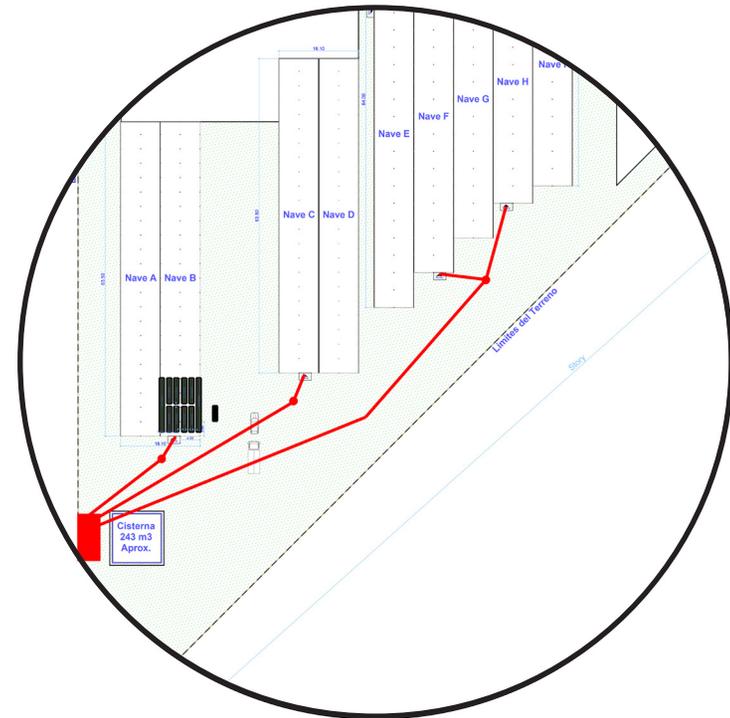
Detalle de plano de levantamiento donde se observan accesos de naves y distancias de recorrido. Elaborado por Héctor Patiño
